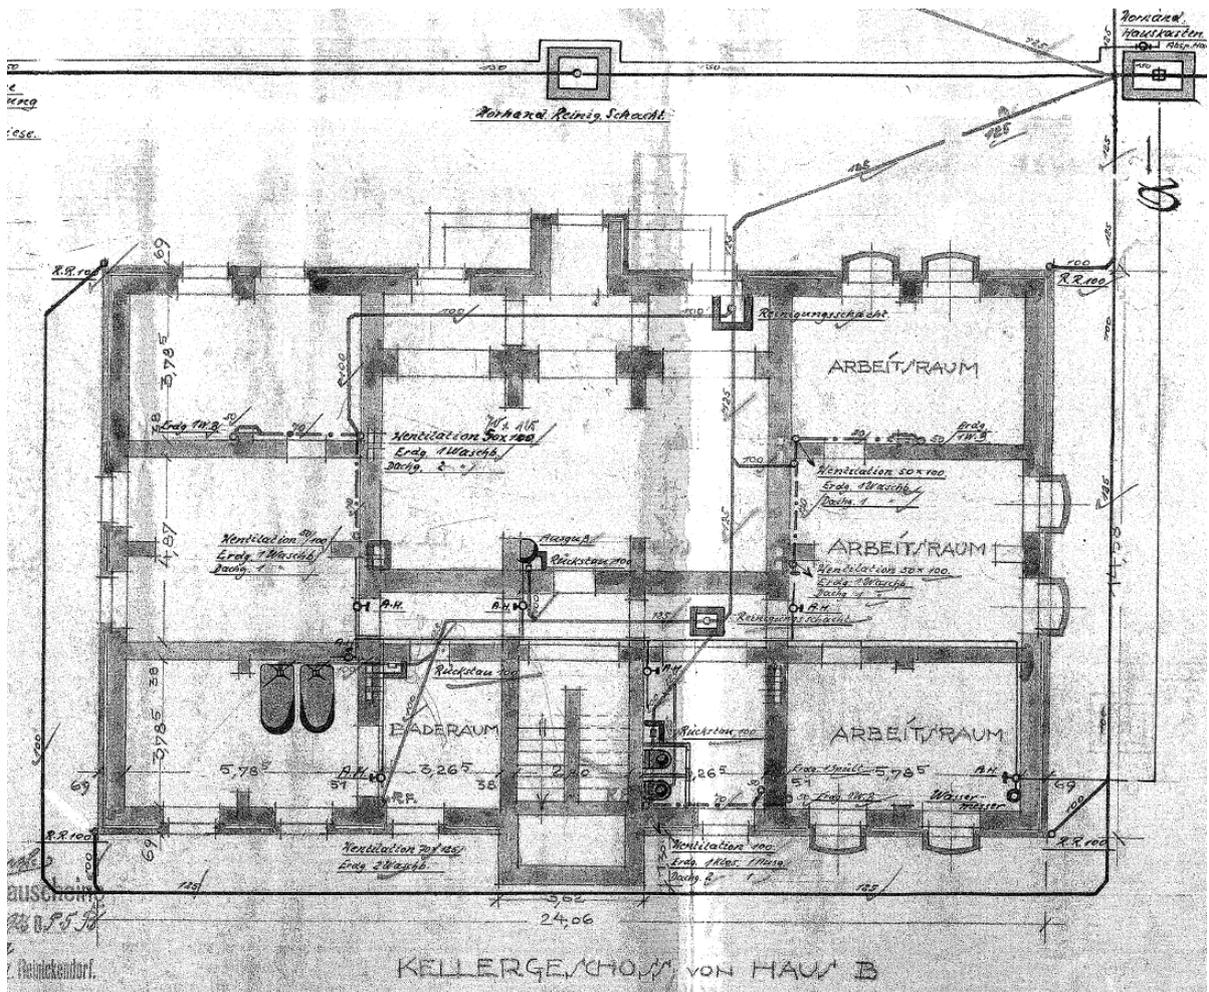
Grundriss Kellergeschoss Haus B mit Markierung der Funktionsräume<sup>72</sup>
